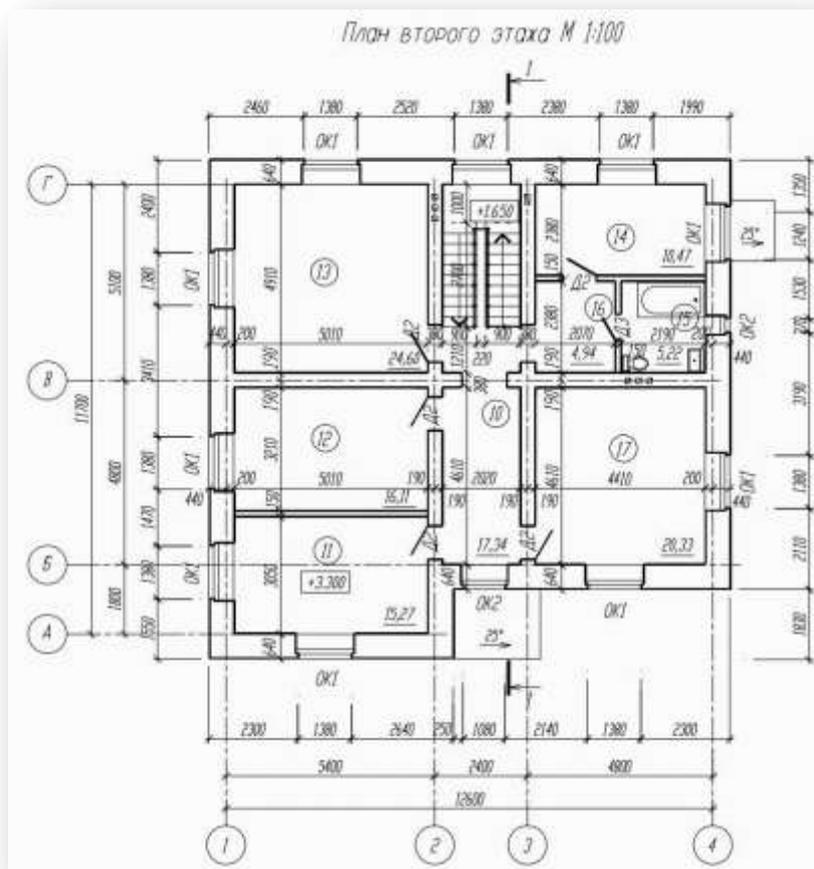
Размеры и условные обозначения на чертежах санитарно-технического оборудования
